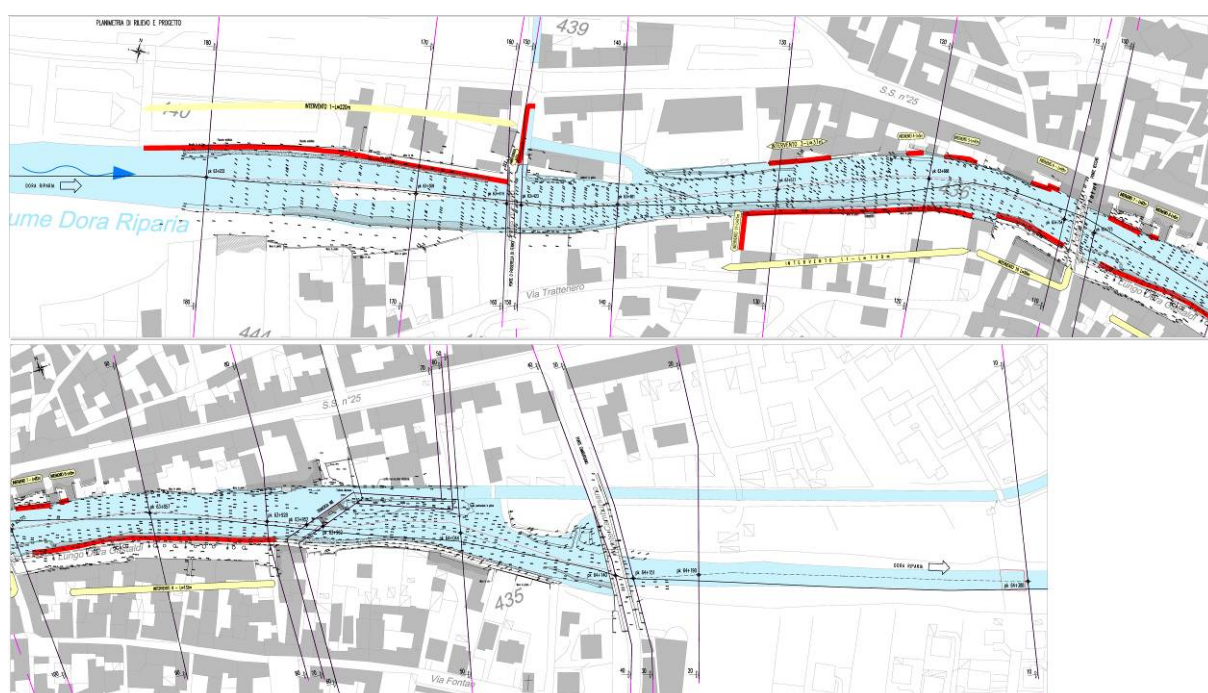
Planimetria del progetto con in rosso le aree interessate da attività di scavo
